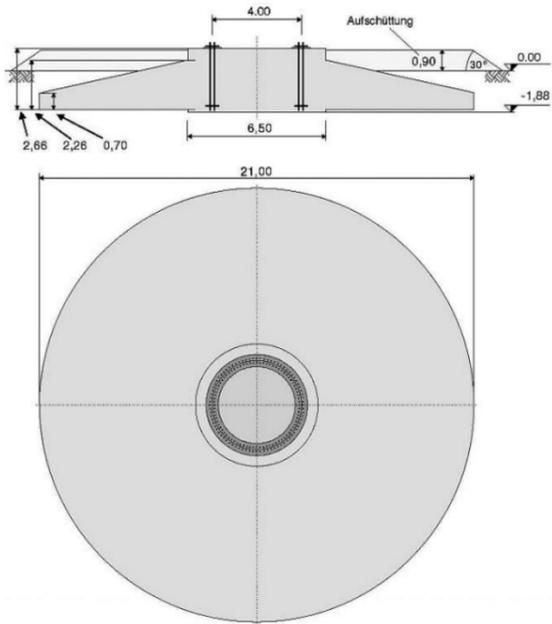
Coupe de principe d'une fondation (source : Nordex, 2017)
